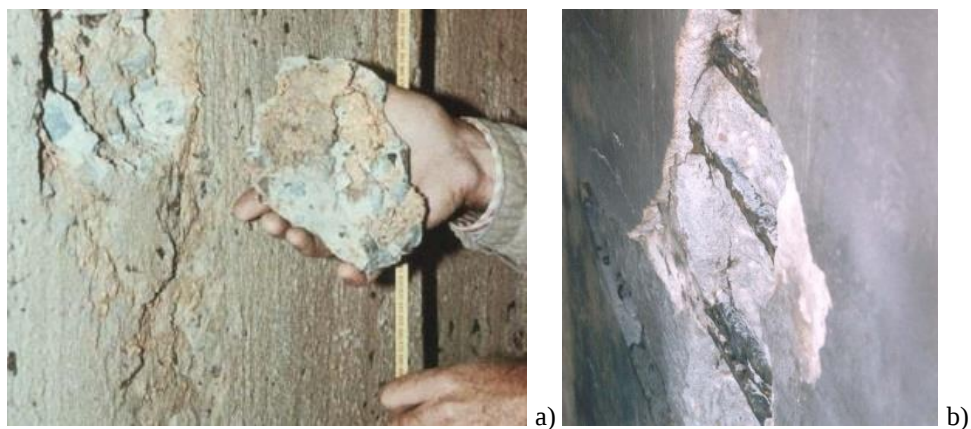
Delaminação: a) causada por reações expansivas no betão; b) provocada por corrosão de armaduras
